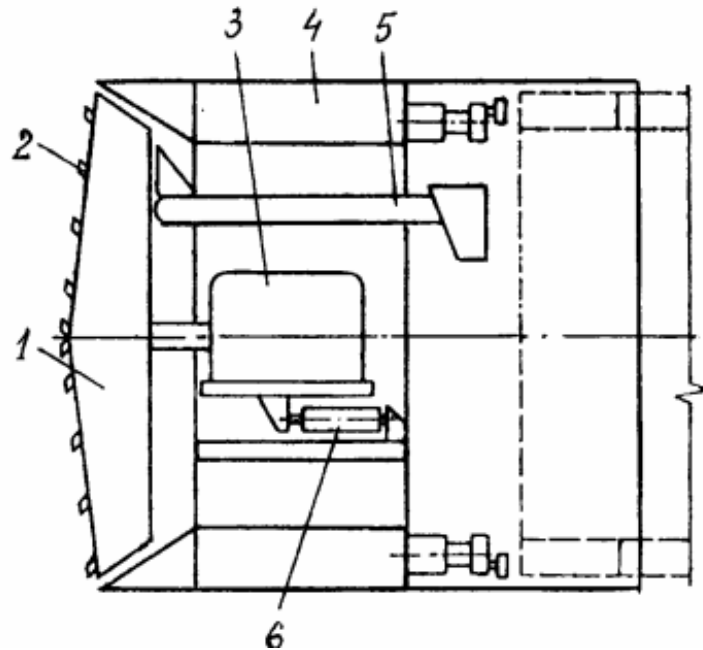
Принципова схема механізованого щита: 1 – виконавчий орган; 2 – породоруйнівний інструмент; 3 – головний привід; 4 – корпус щита; 5 – щитовий транспортер; 6 – пристрій подавання виконавчого органу на вибій
